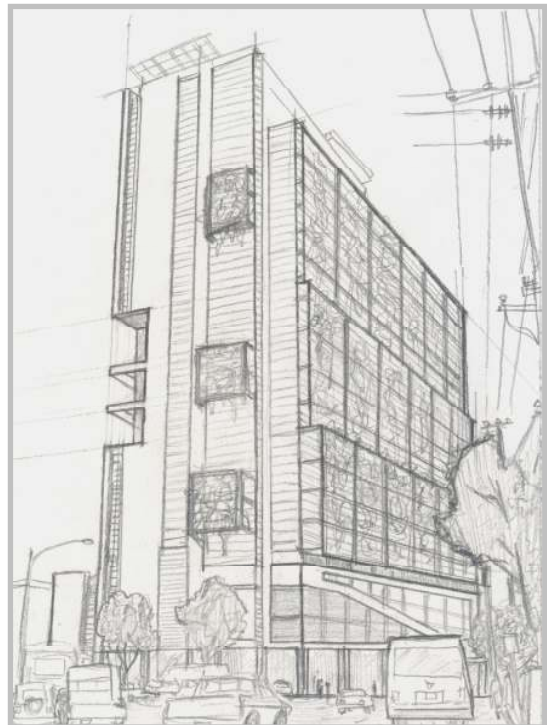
Croquis estructura metálica portante escalonada con vegetación.
